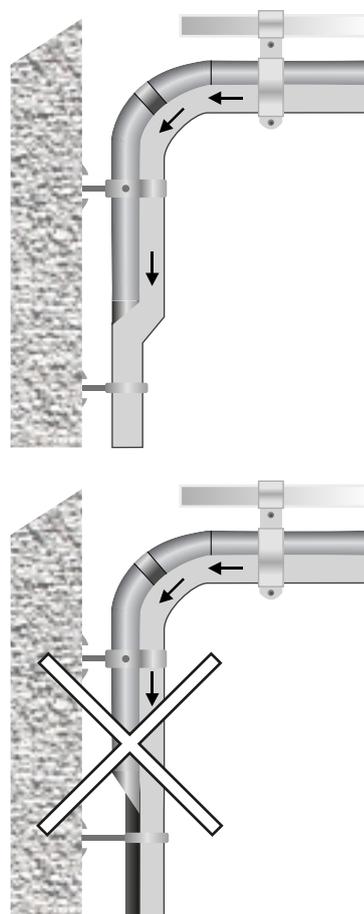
Instalação de redução excêntrica do tubo vertical com a face virada para a parede.
